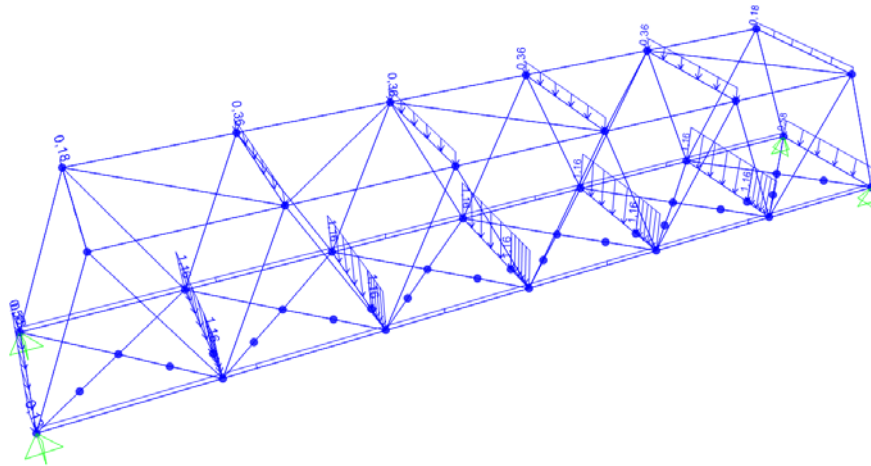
cargas muertas sobre la estructura. SAP2000
